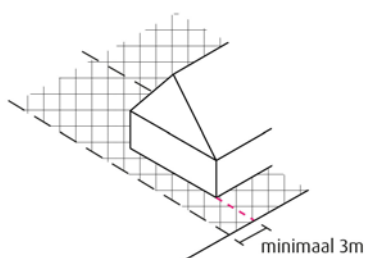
Gevarieerde bebouwing en afwisselende rooilijn.
